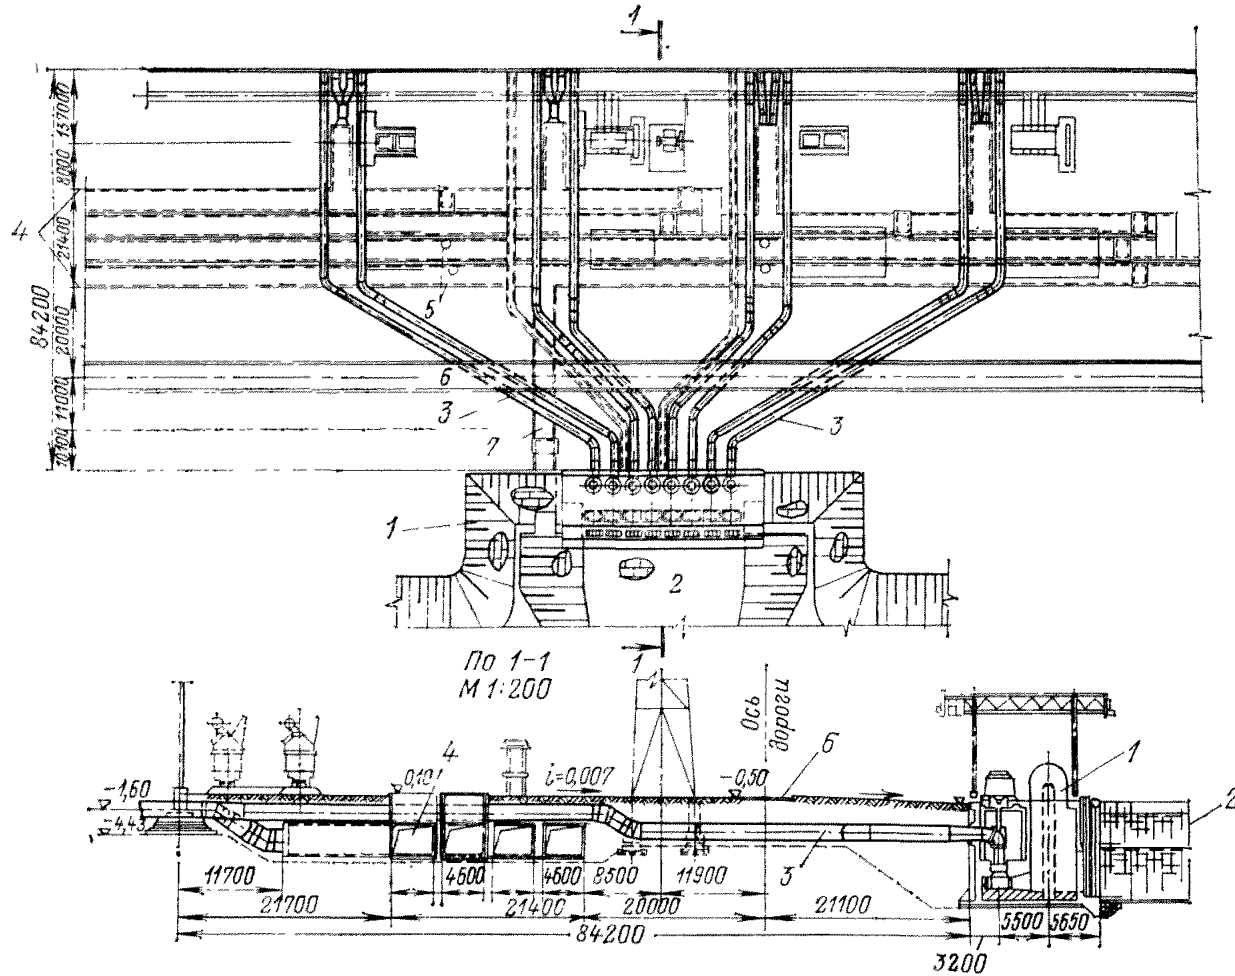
Расположение напорных трубопроводов при блочной схеме технического водоснабжения. План и продольный разрез.
